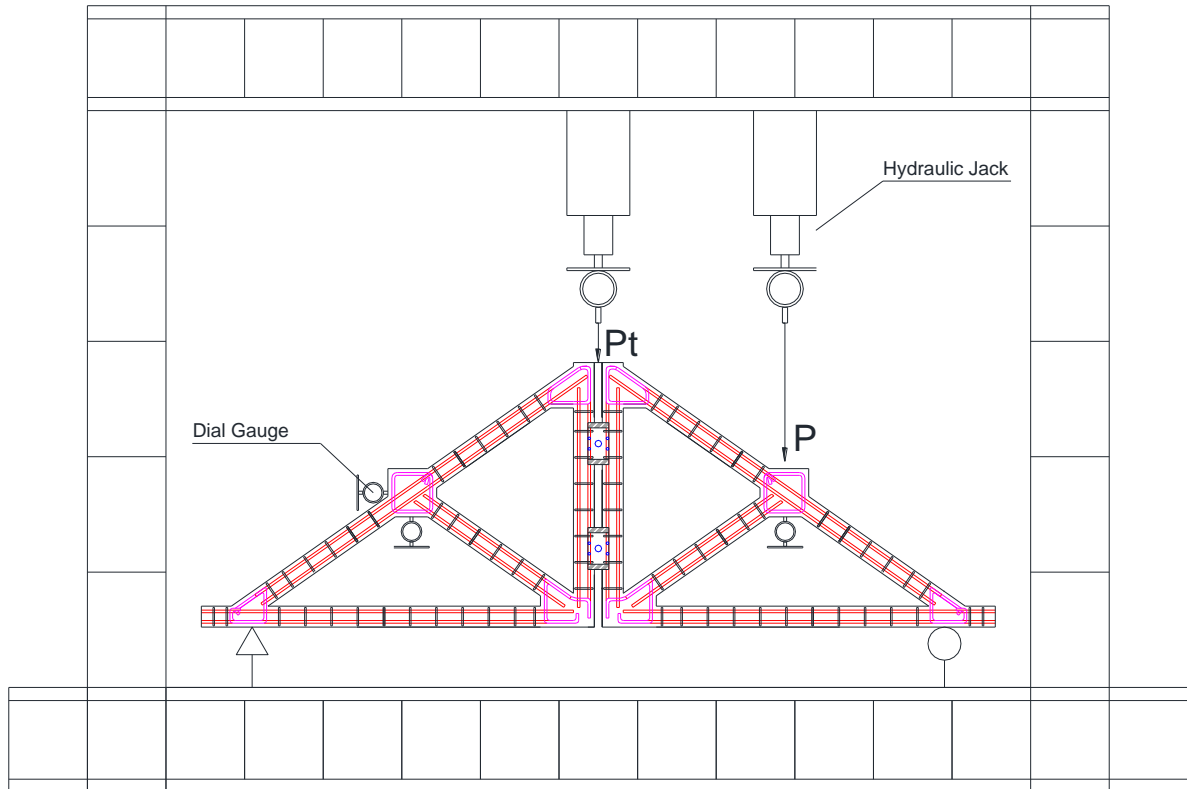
Detail Sambungan grouting kuda-kuda
